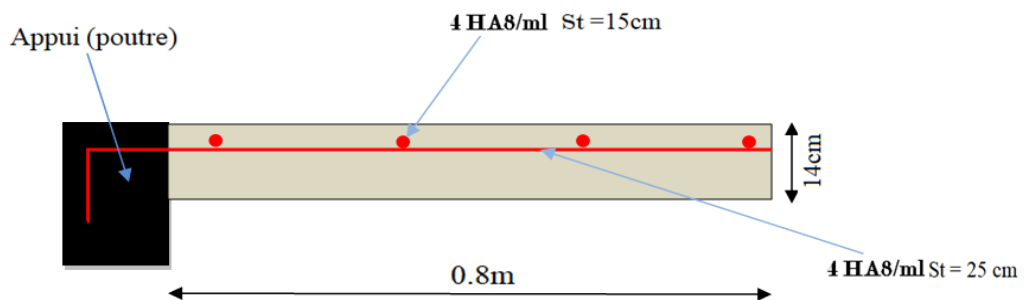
Schéma de ferrailage de la dalle pleine type N° 3
